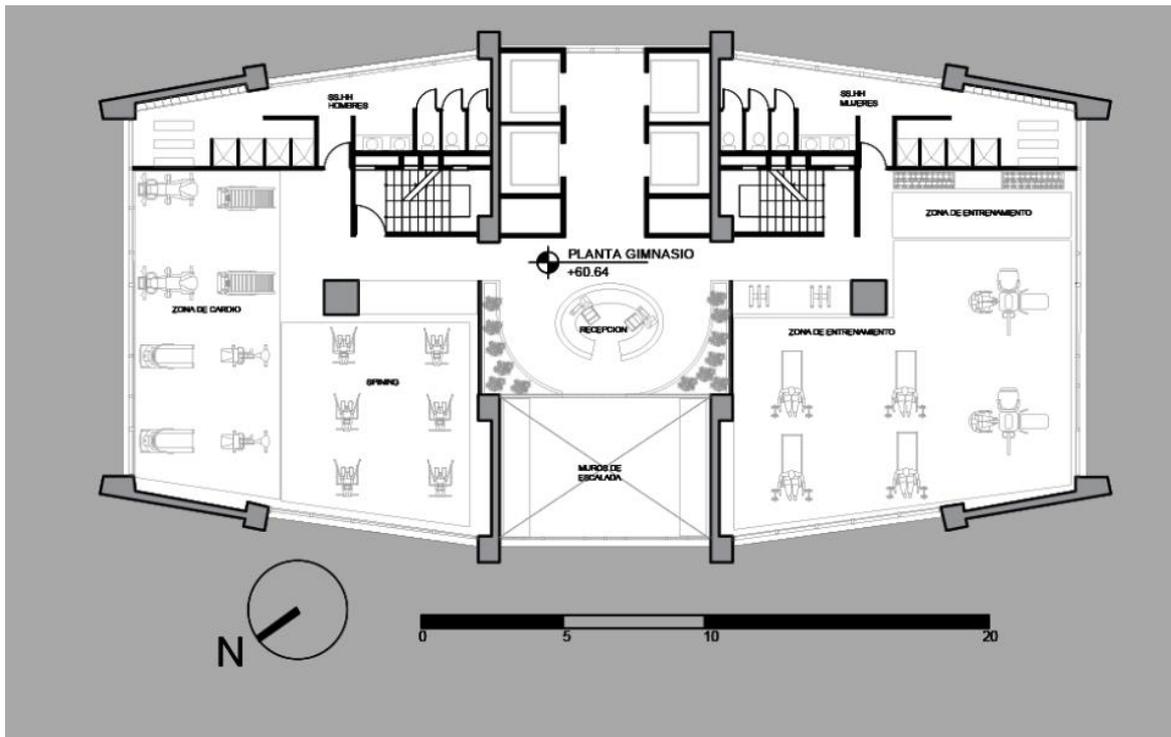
PLANTA NIVEL 18. Elaboración Propia.
